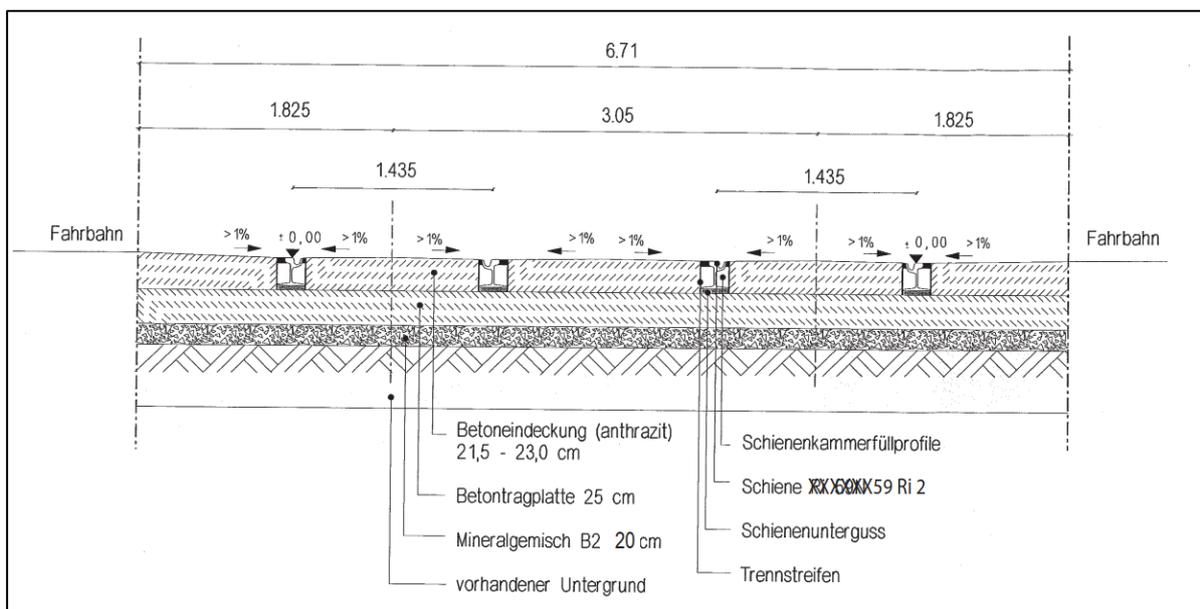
Regelquerschnitt Rillenschiene-Oberbau Fahrbeton in Knotenpunkten: Geschlossener Oberbau mit kompl. Betonaufbau (Quelle: BSAG)
